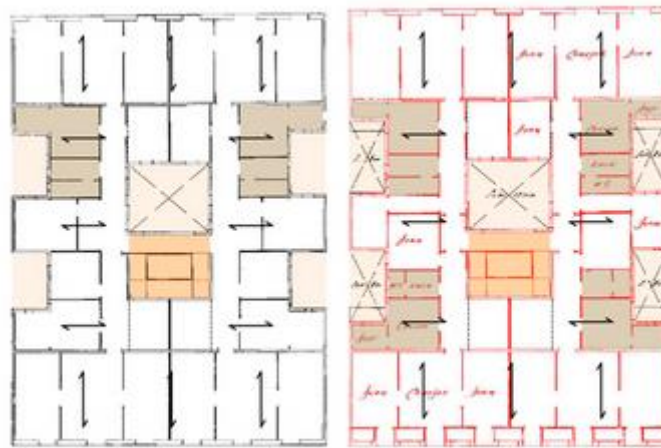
Planta tipo 1900 (izquierda) vs. Planta recrecida 1928 (derecha) caso 1. Fuente: <http://ecbarquitectura.com>
